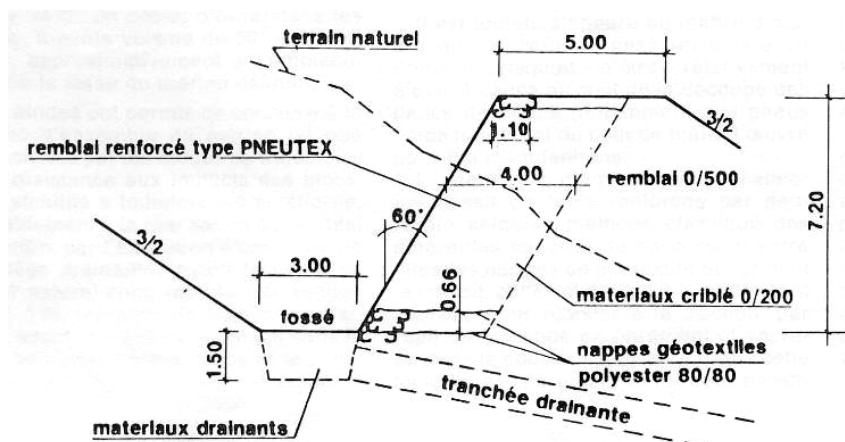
Coupe schématique du merlon d'Aigueblanche, d'après Lapierre et al. 1990.
